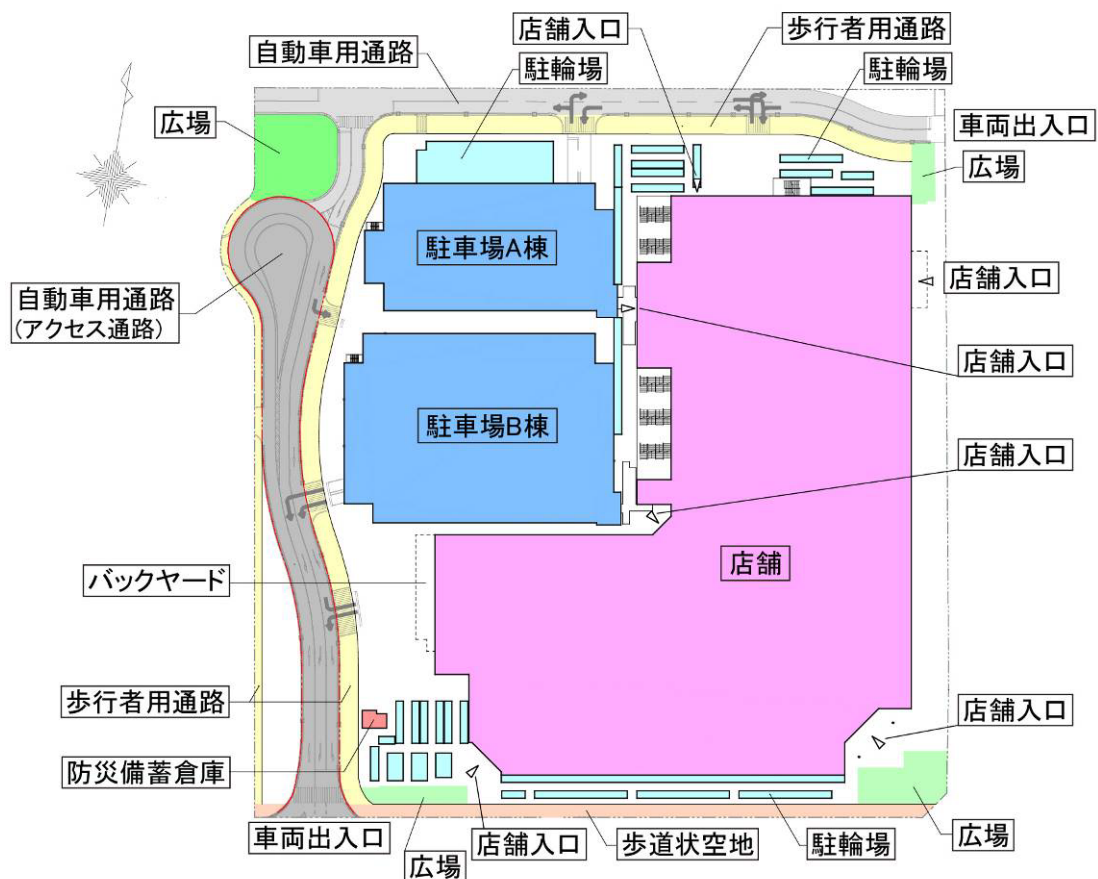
(1) 各階平面図(商業棟 1 階, 駐車場棟 1 階)【変更後】
